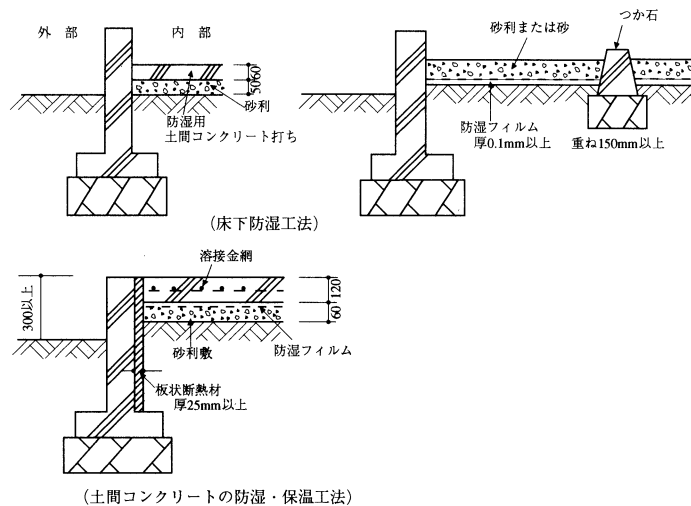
床下および土間コンクリートの防湿・保温工法（単位：mm）（住宅金融公庫仕様による）
